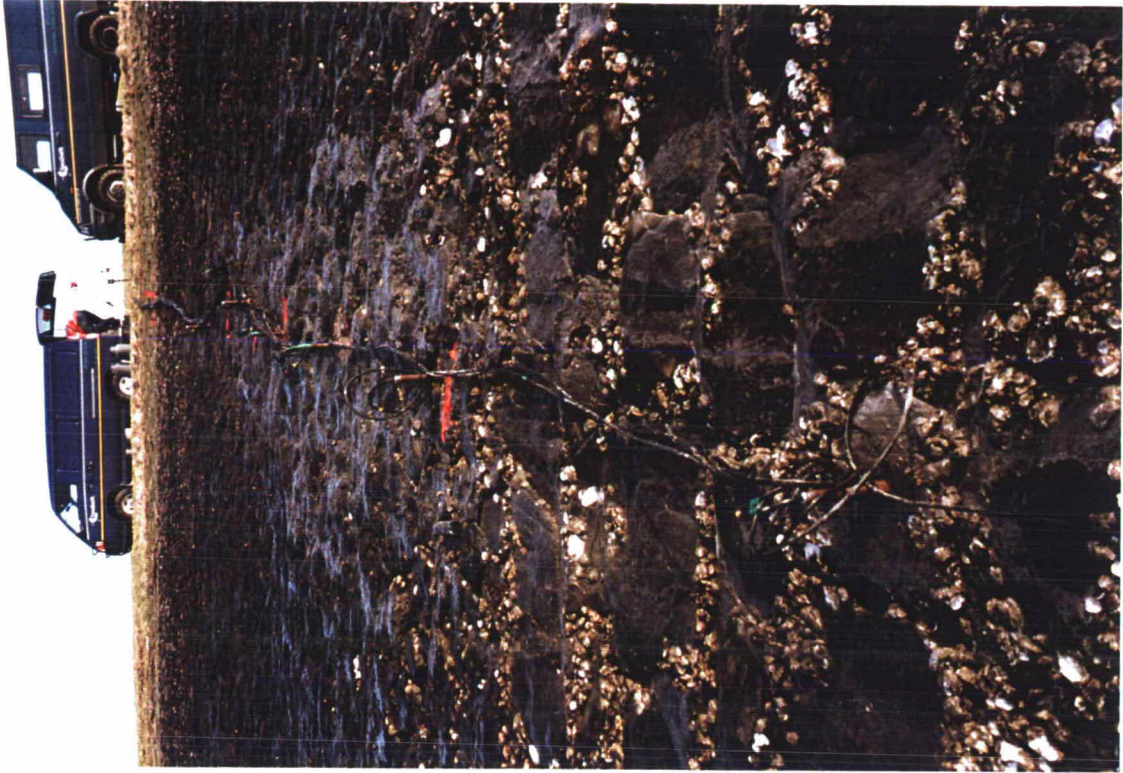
Meetopstelling van de getijmeting bij dp 29+35m in bekledingsvak 16203 en 16501
